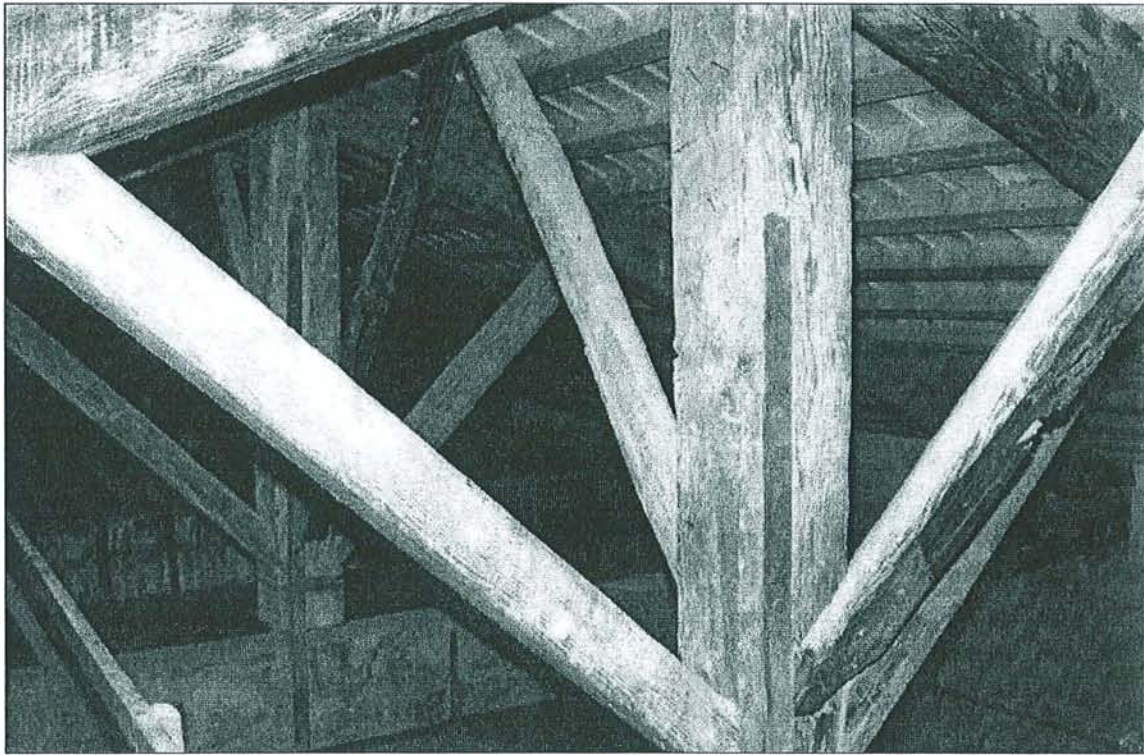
Cathédrale de Palermo. La couverture centrale (Photo: Pizzo).
